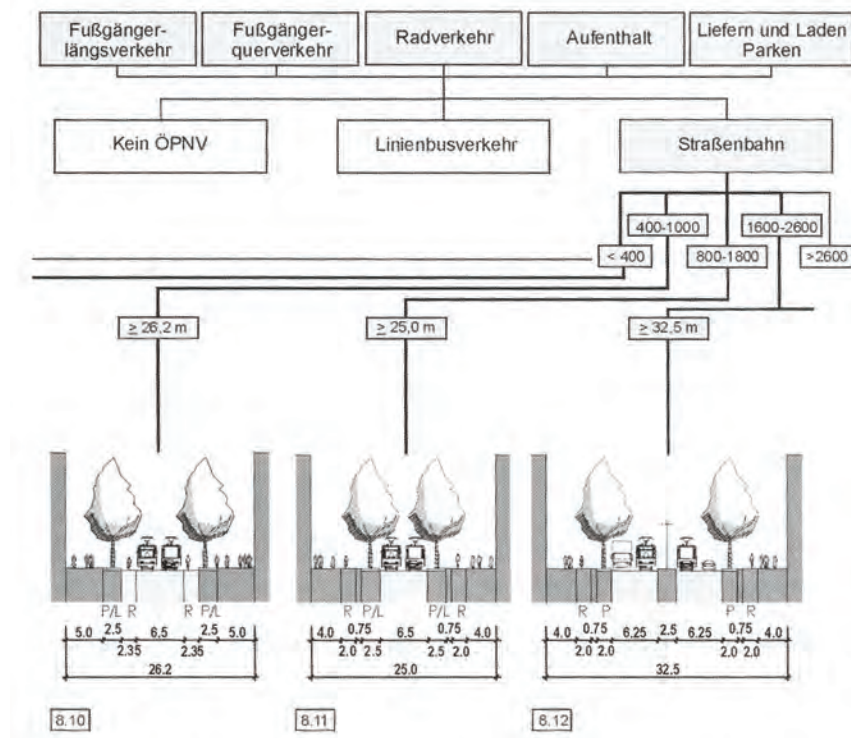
Empfohlene Querschnitte Typ 8 - Hauptgeschäftsstraße (RAST 06)
